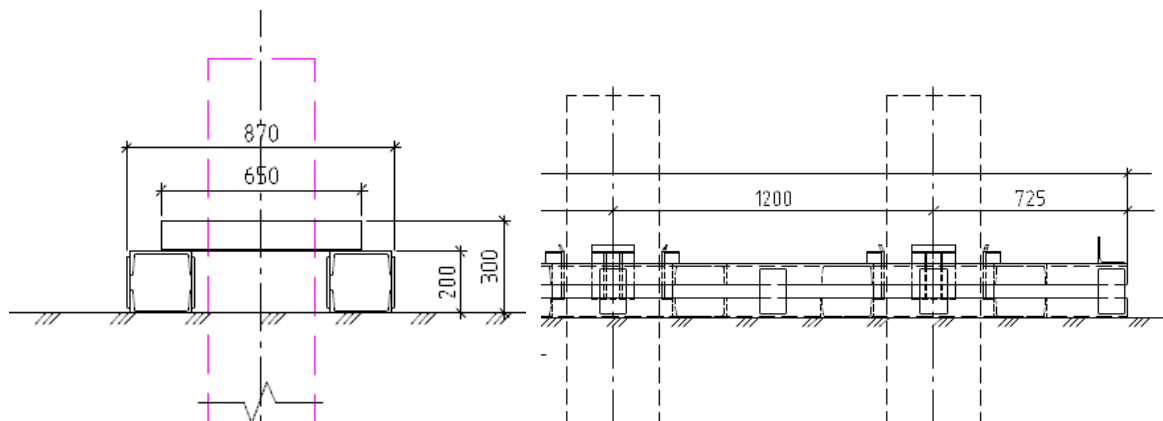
Чертеж нового кондуктора (вид сбоку)
